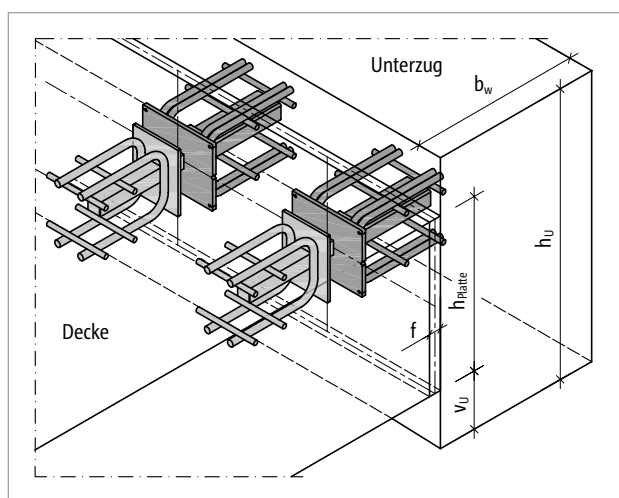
Bemessungsbeispiel Anschluss Decke an Wand
